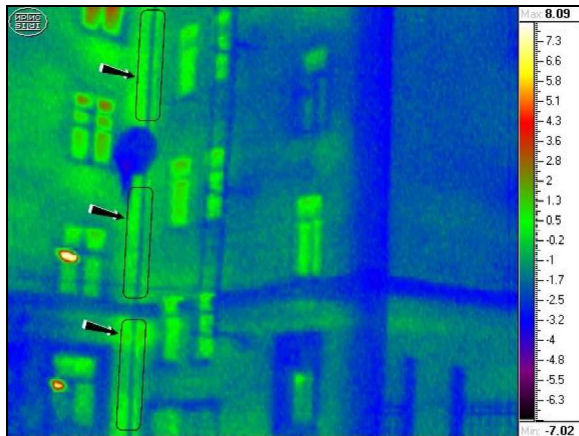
Дефект конструкции здания. Стык между фасадами С и D
